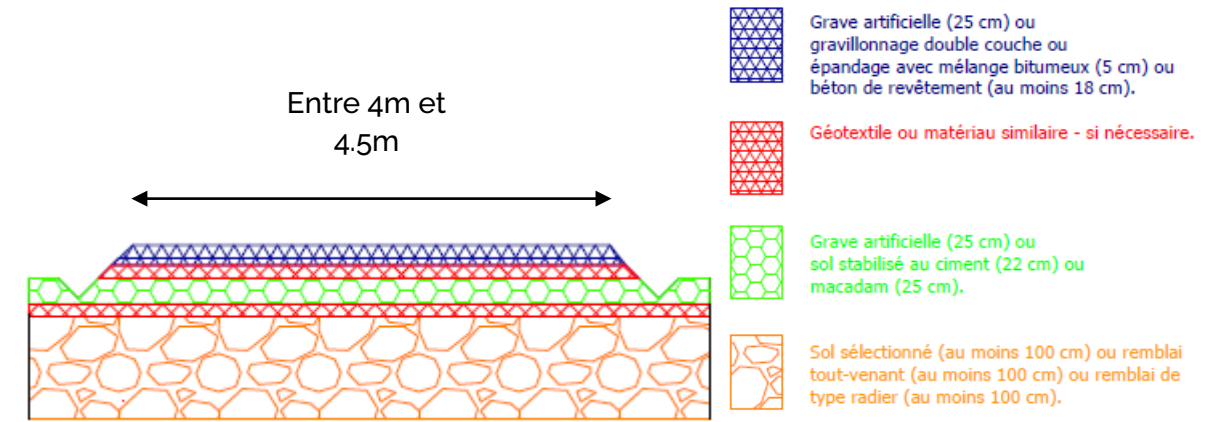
Vue en coupe des pistes à créer/renforcer
